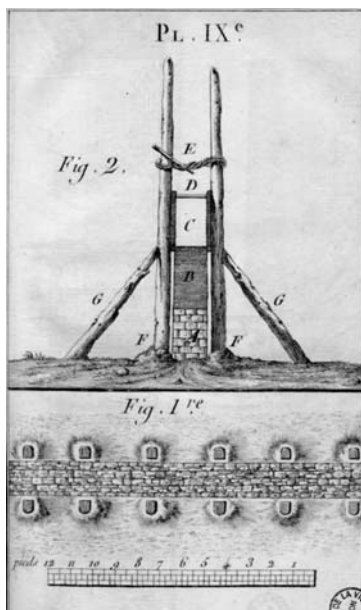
Sección vertical y horizontal del encofrado de un muro de tapial.
